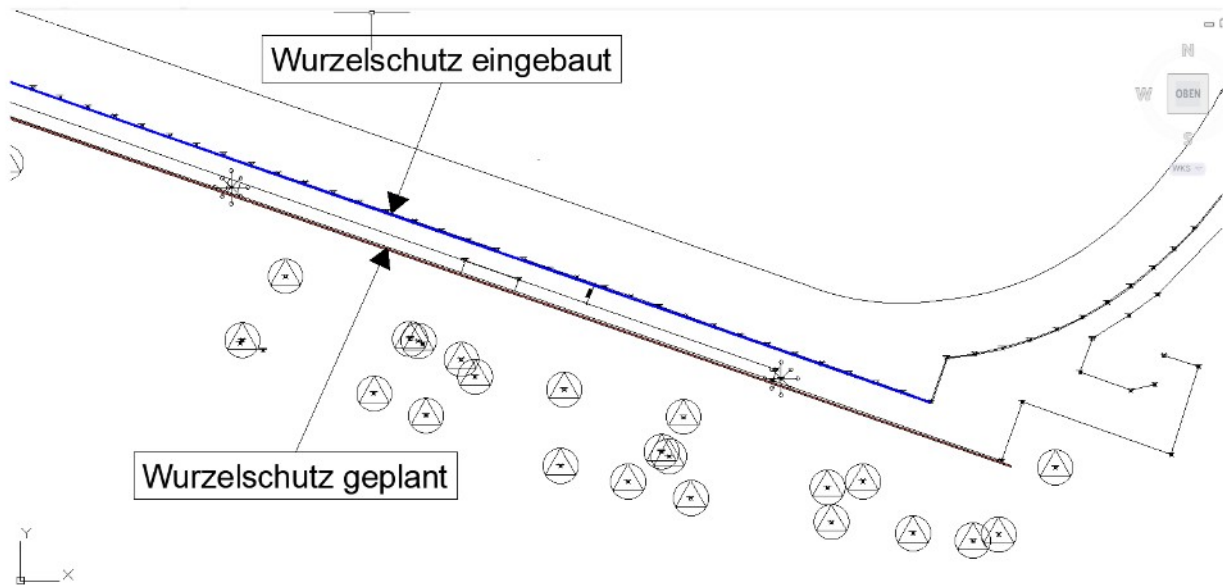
nach Hinweisen der Baufirma zusätzlich durchgeführte Sichtungen zum eingebauten Wurzelschutz, Einbau erfolgte an falscher Stelle, rot – geplant, blau - vorgefunden
